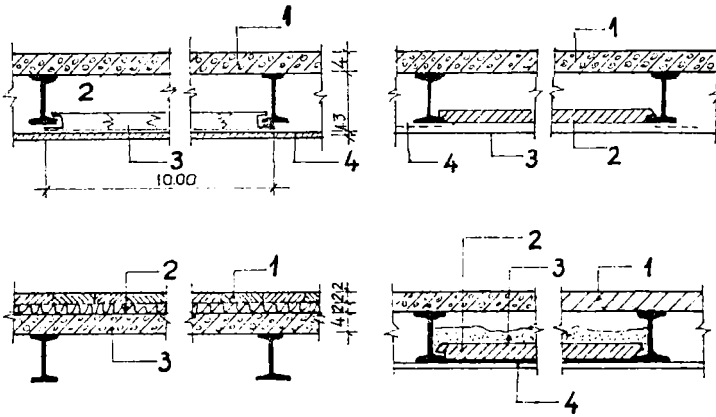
Planșee cu profile metalice și dale de beton monolite
